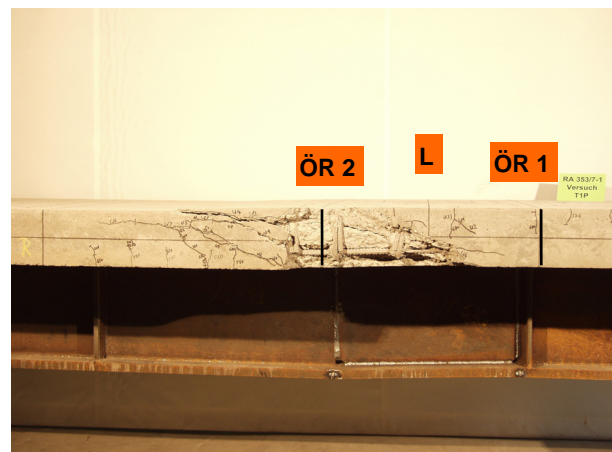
Rissbild auf der linken Betongurtseite
